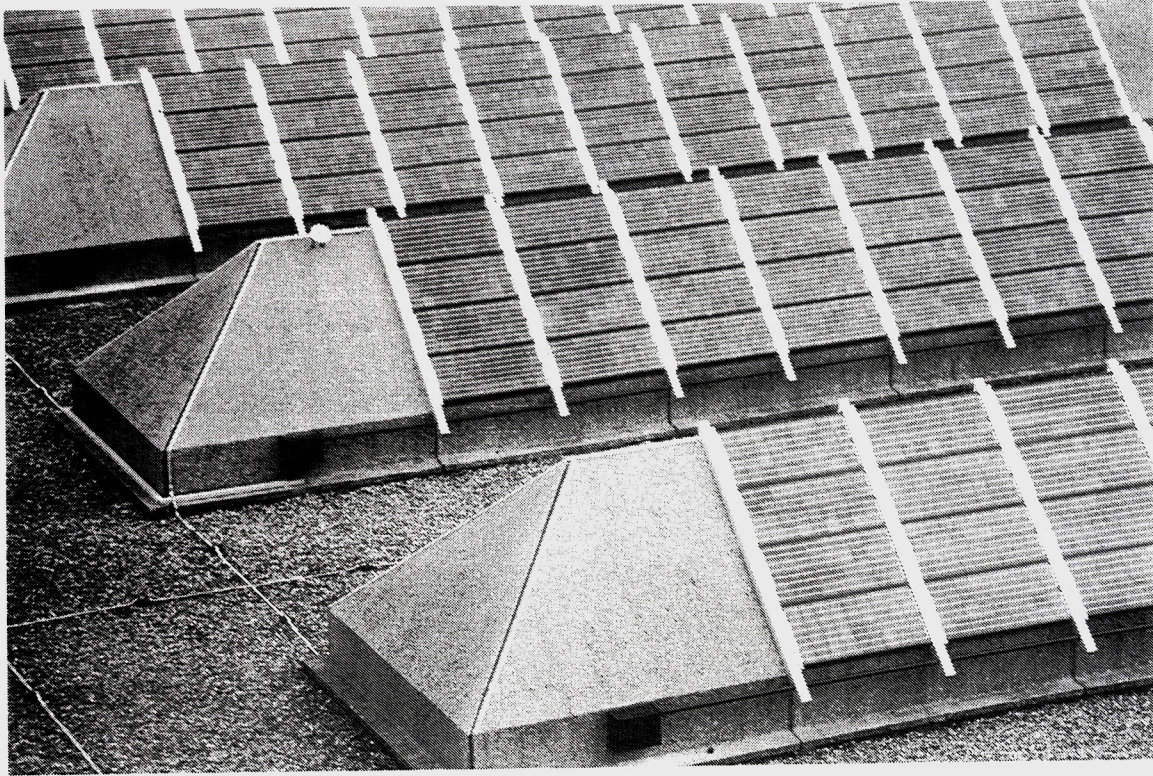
Détails de l'introduction des câbles dans la halle : avec câble apparent (shed central) et avec entrée directe (autres sheds).
